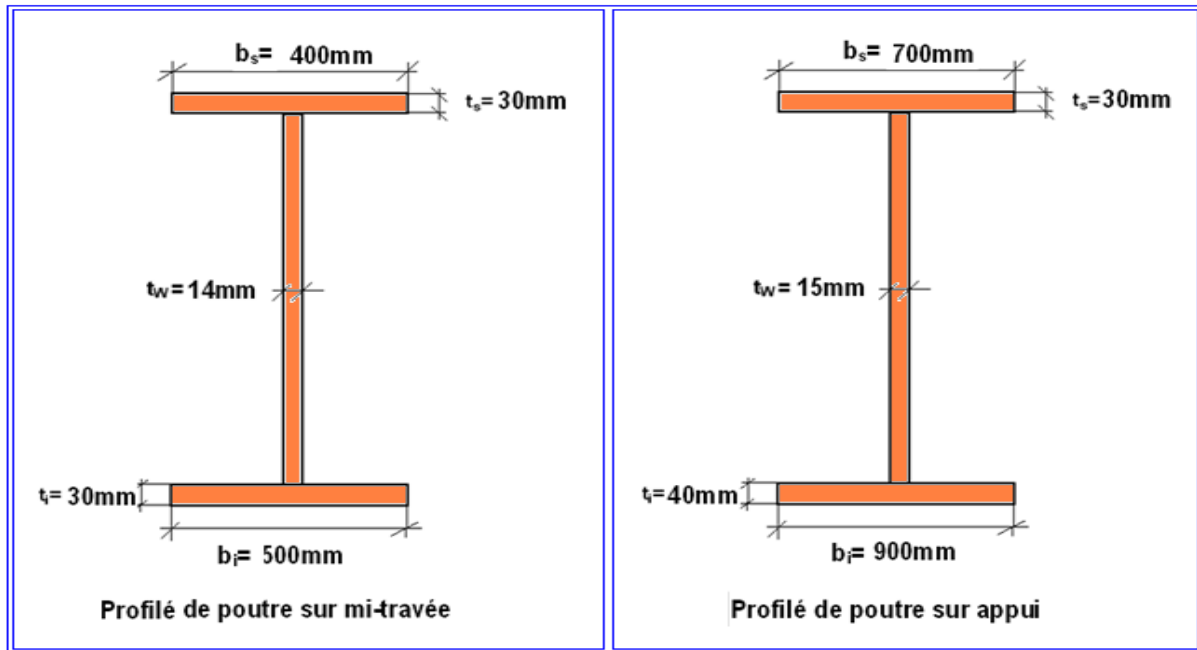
Profilé de poutre à mi- travée et sur appui
